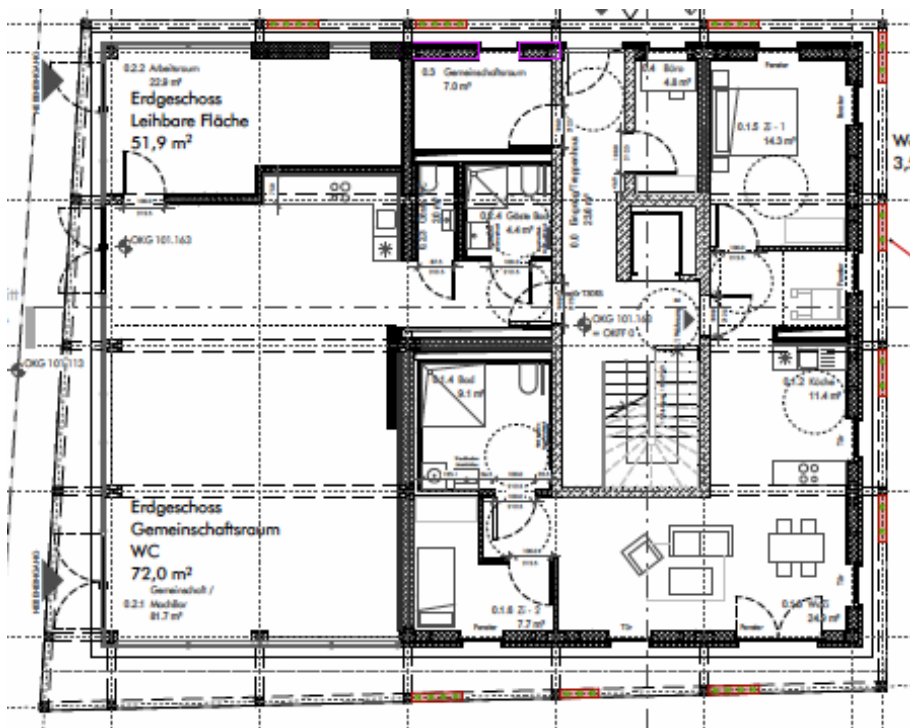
Grundriss des Erdgeschosses, rot markierte Felder bezeichnen die bodengebundenen Pflanzflächen, die sich an drei Seiten der Fassade, mit Ausnahme der Südfassade, finden. Im Grundriss werden auch die abgekippten Seiten der Süd- und Ost-Fassade ersichtlich, die sich nicht im exakten 90-Grad-Winkel zu den Gebäudewänden befinden. [© DGJ Architektur GmbH]
